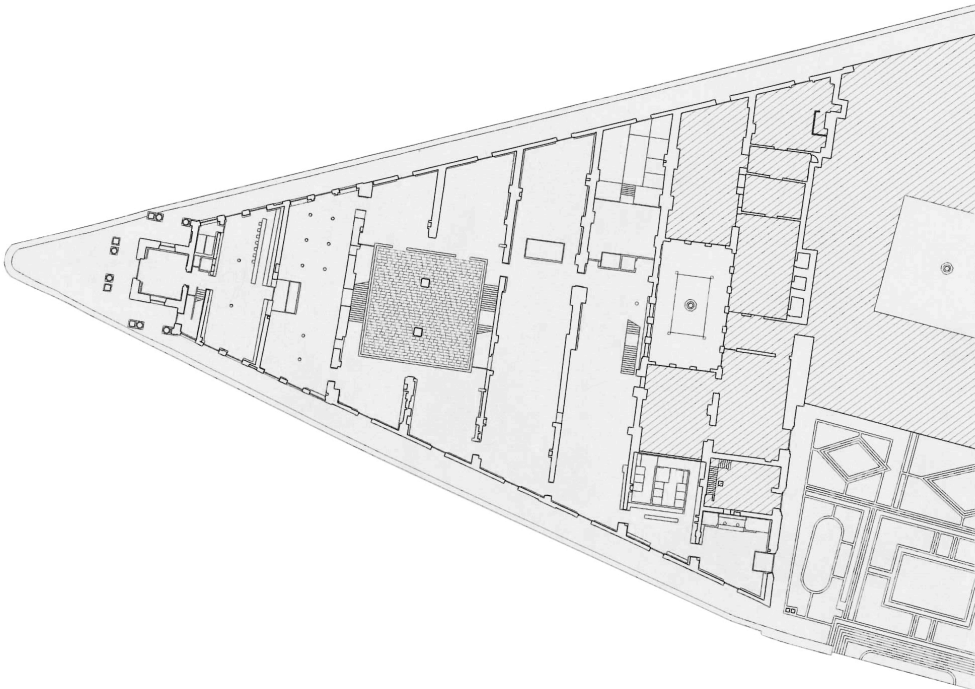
Erdgeschoss Grundriss *Punta della Dogana*, Tadao Ando.
